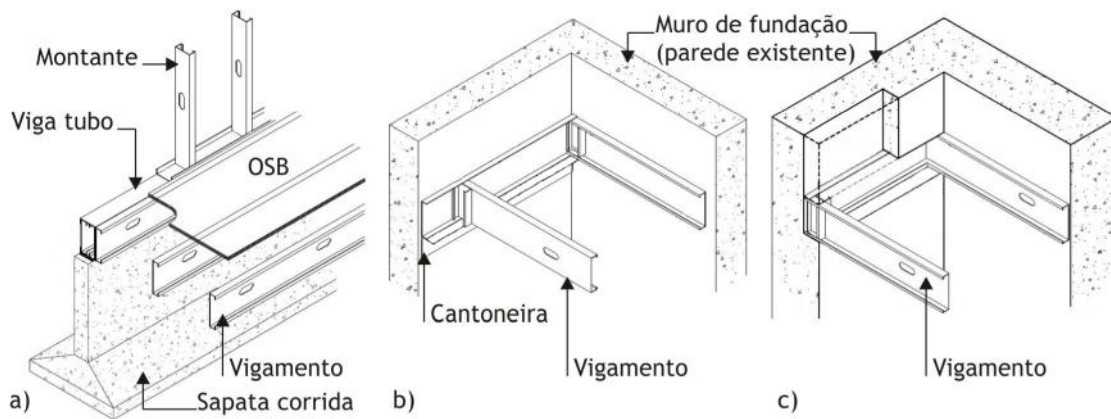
a) apoio direto; b) apoio interior; c) apoio encastrado. Adaptado de: ConsulSteel, 2002.
